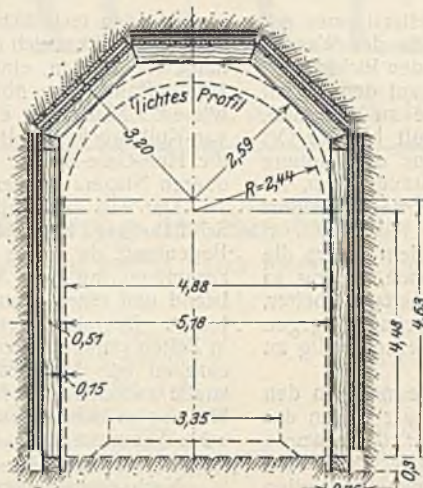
Eisenbahntunnel. Zimmerung in nicht tragendem Gebirge.
